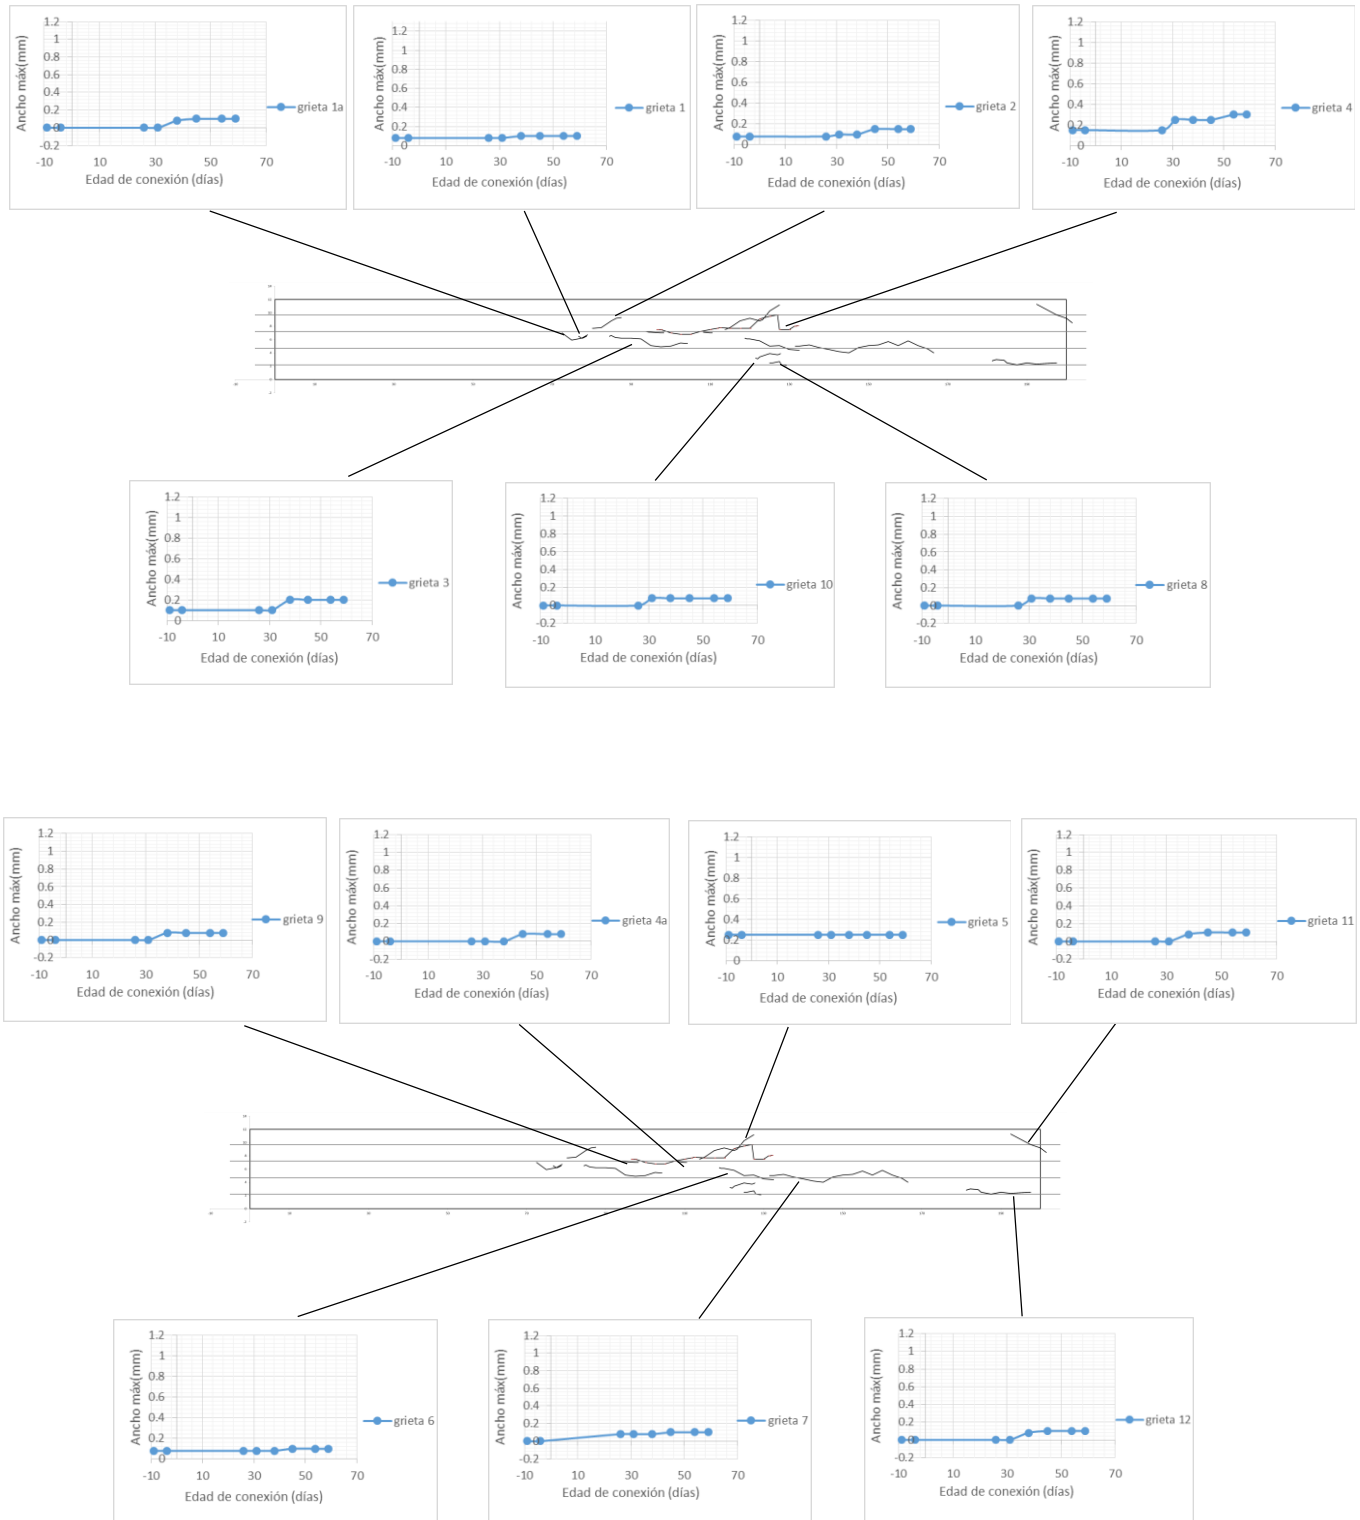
Localización y ancho máximo de grieta viga VCPC2.
